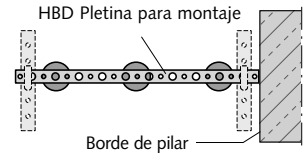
Combinación de 2 elementos HDB: vista en planta
